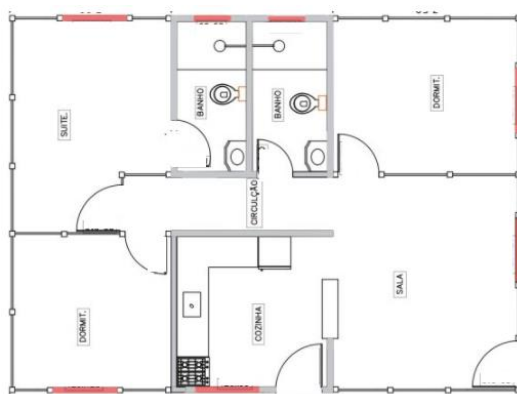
Planta e vista de um módulo, T3 com um piso, localizado na cidade de Muqui [26]
